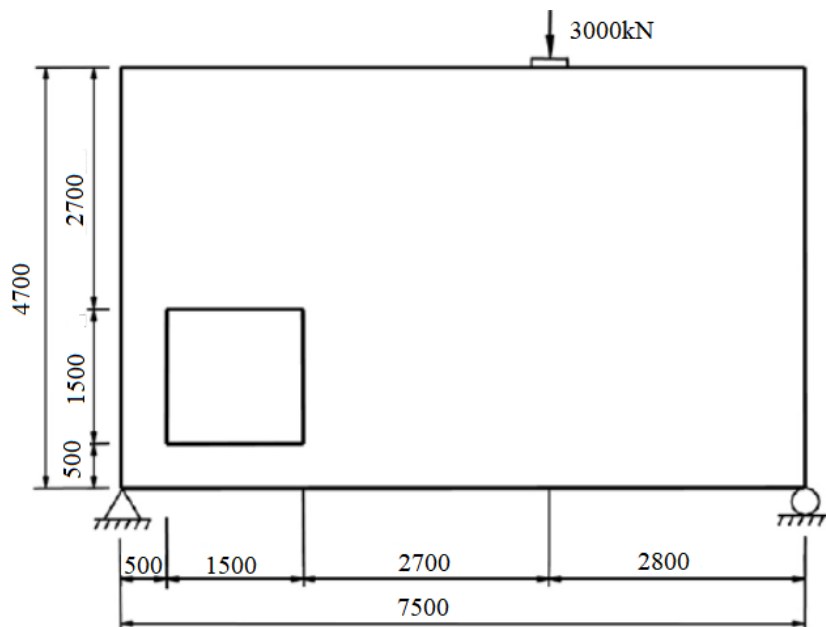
Viga biapoiada com abertura (Adaptado de Schläich *et al.*, 1987)
